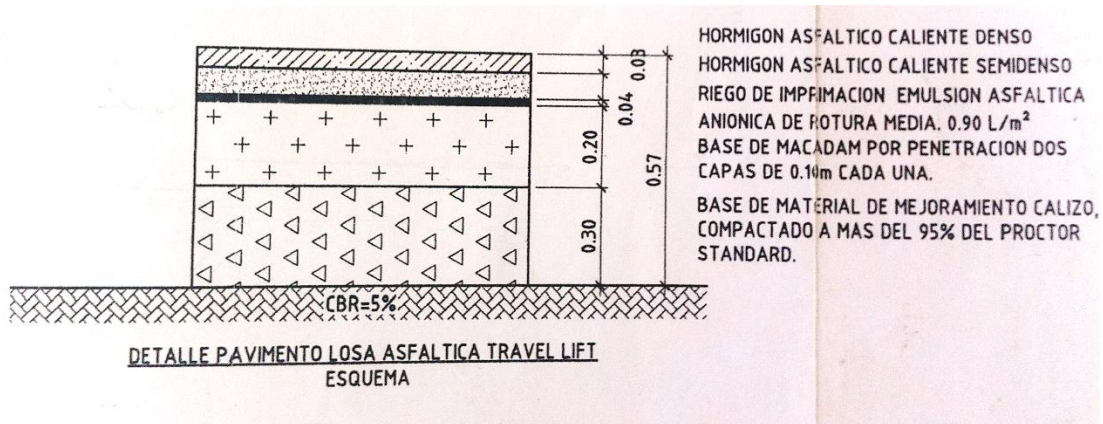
Detalle pavimento losa asfáltica Travel Lift. Fuente: Plan General. Cálculo de espesor de pavimento asfáltico de la losa del Travel Lift. Memoria de cálculo.
